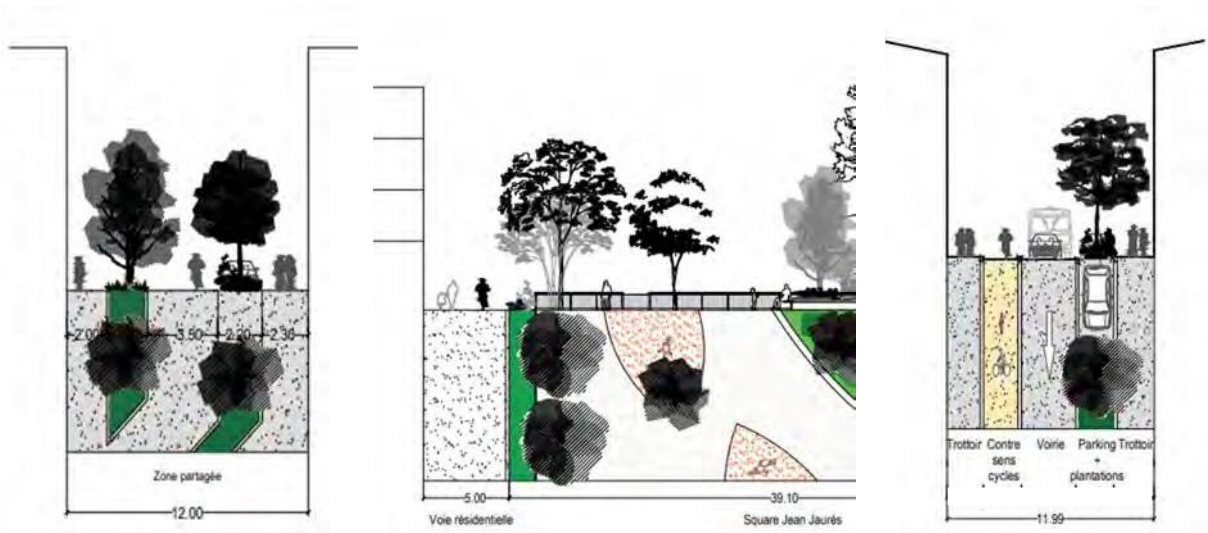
Profil en travers type de la rue Pierre Sépard, phase AVP : Echelle 1/200ème. Sources : Ingerop/Ilex (2022).
